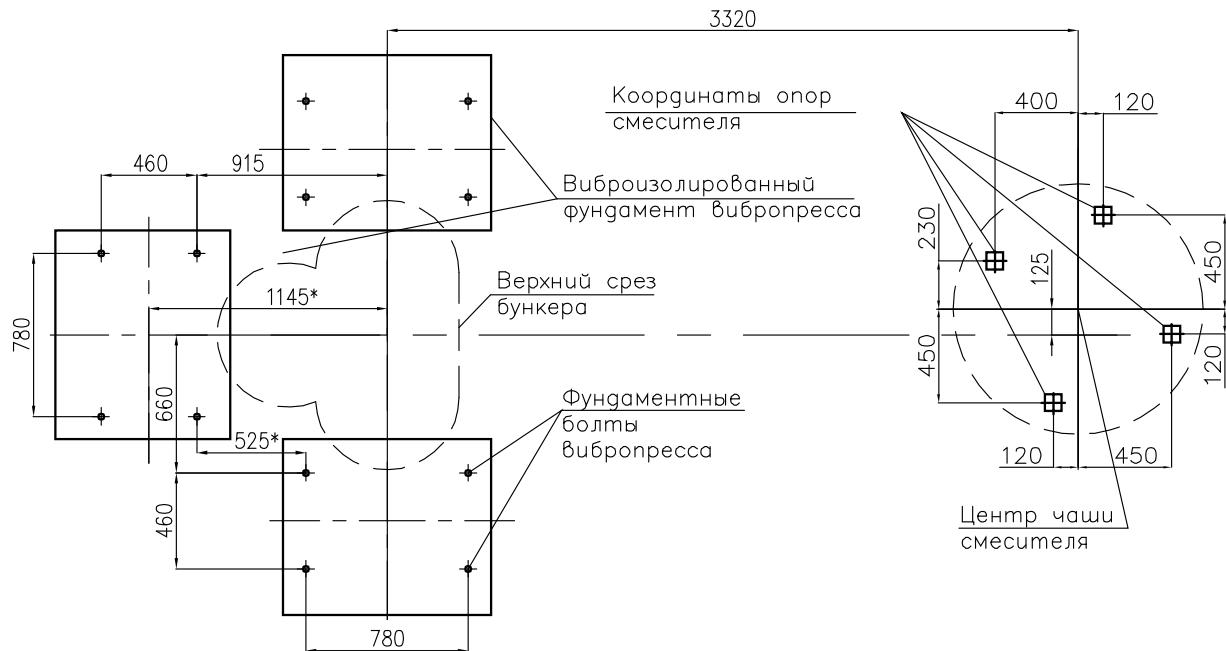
Схема установки вибропрессов, бункера и смесителя.
